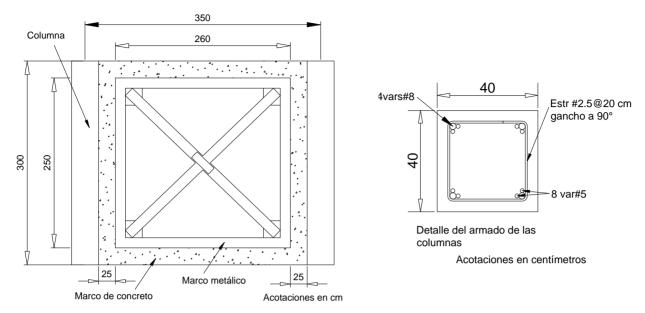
Ejemplos de figuras auxiliares: a) Detalle de un contraventeo; b) armado de una columna
